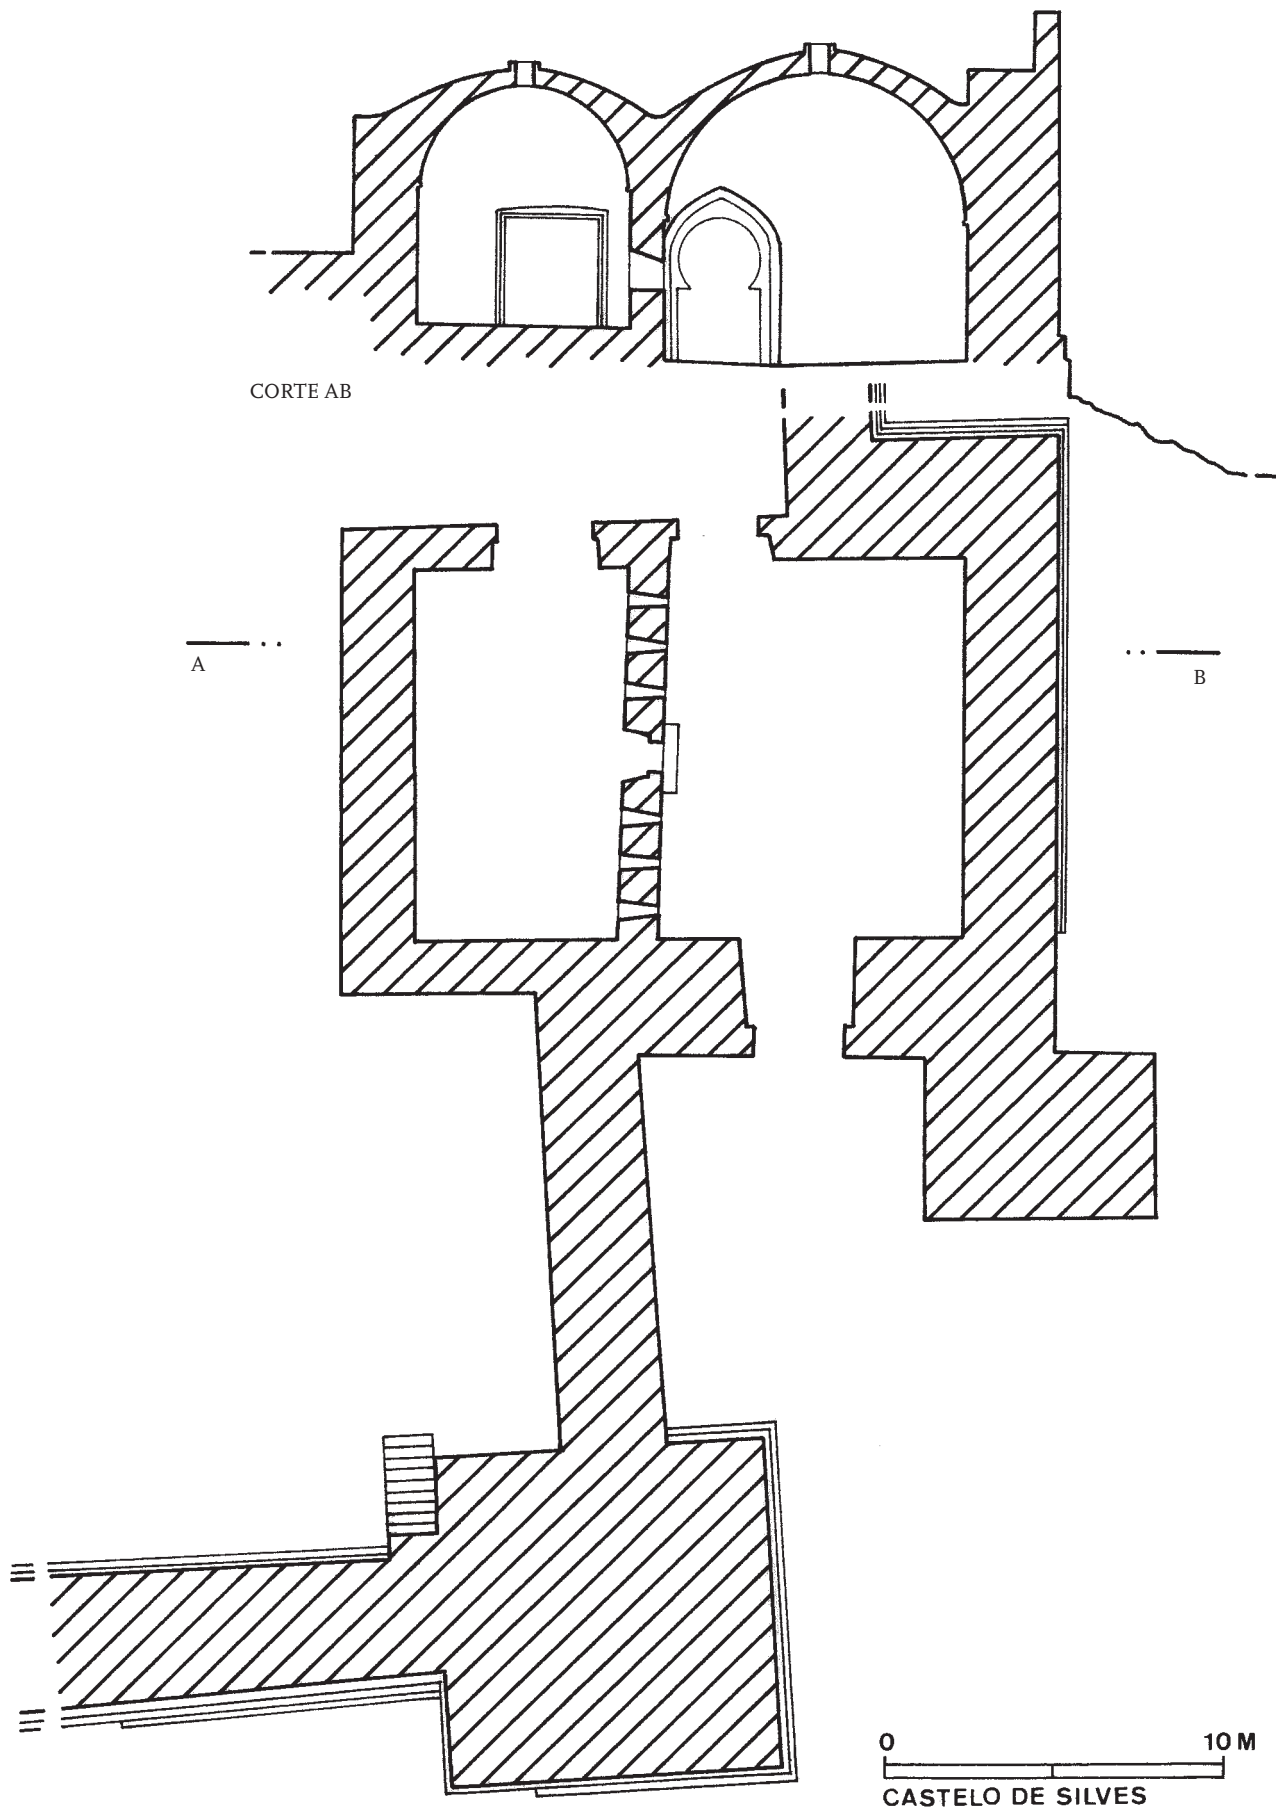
Planta e corte da entrada principal do Castelo de Silves.
